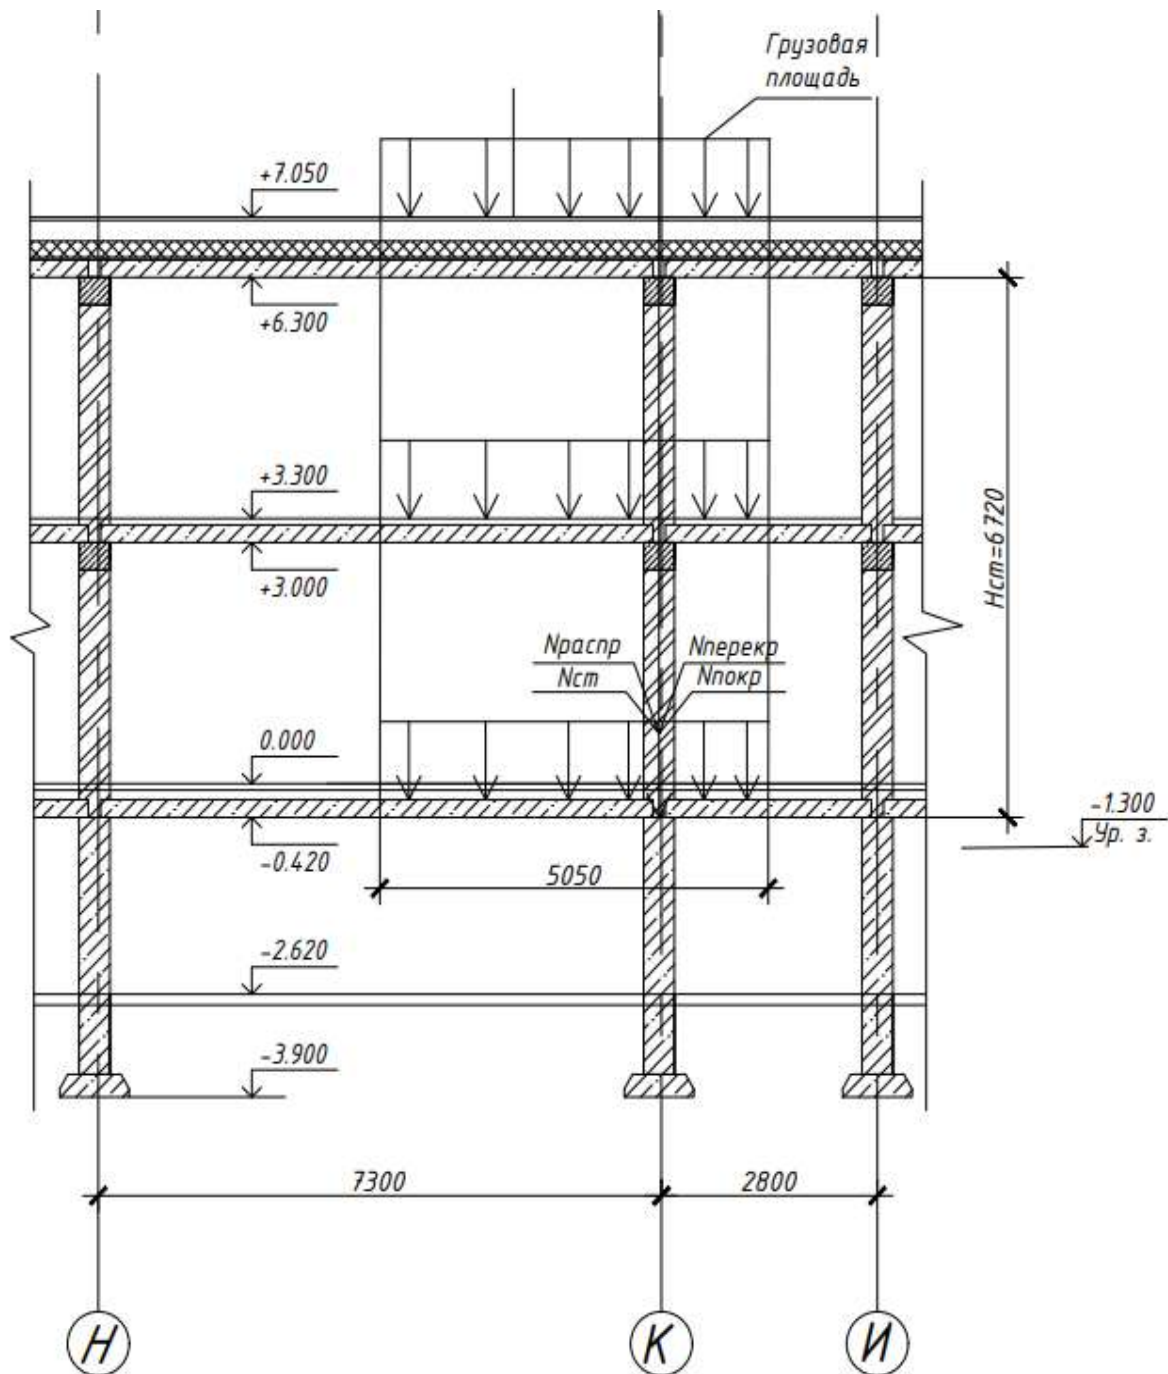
Фрагмент разреза с грузовой площадью для фундаментов, расположенных в оси 2К со схемой распределения вертикальных нагрузок
